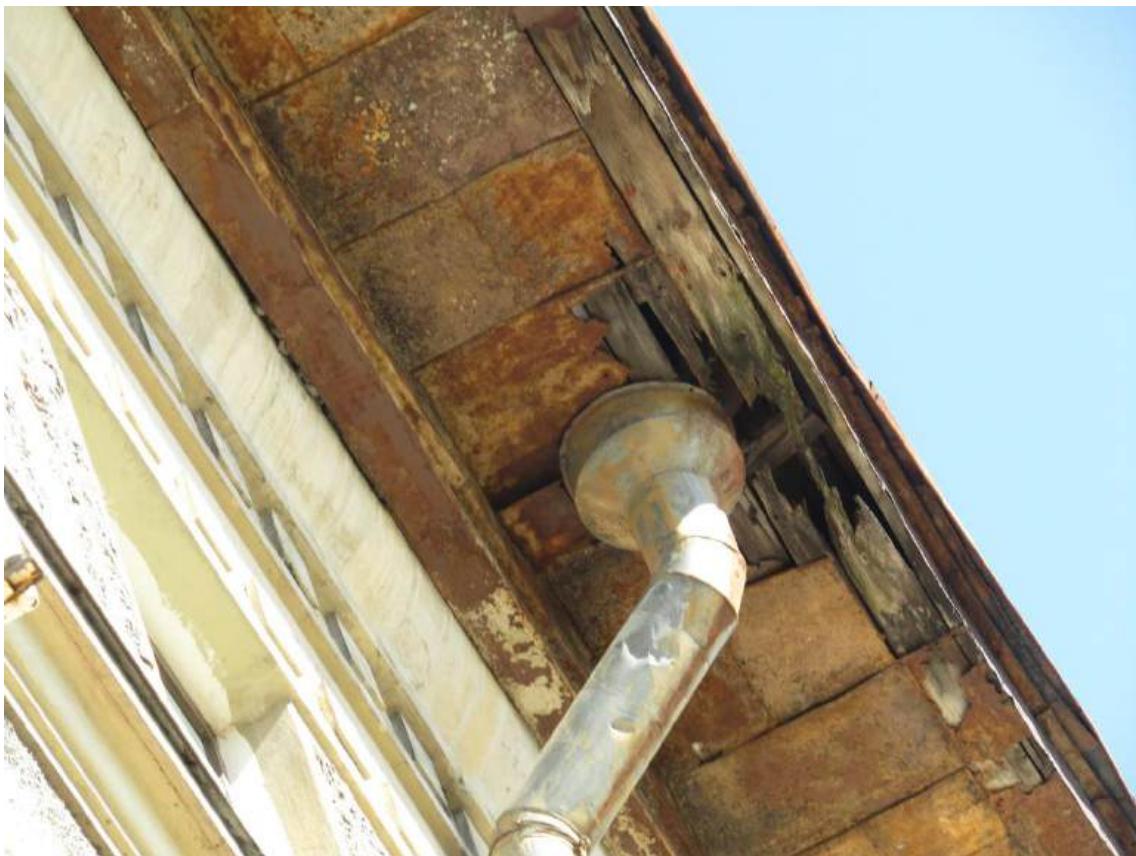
Фрагмент юго-восточного уличного фасада здания. Вынос венчающего карниза.
